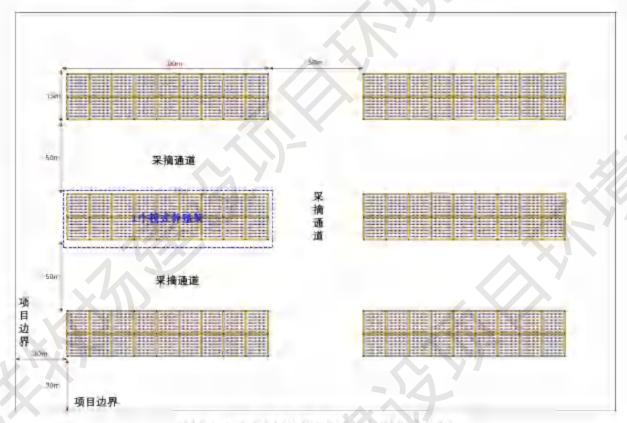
栅架式浮筏养殖区平面布置示意图
